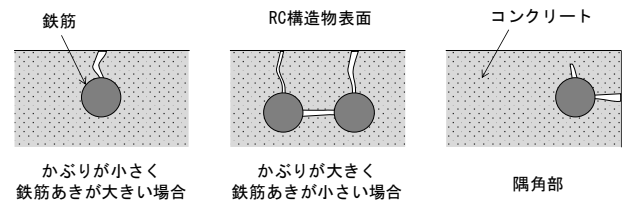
鉄筋の腐食膨張によるコンクリートのひび割れ
